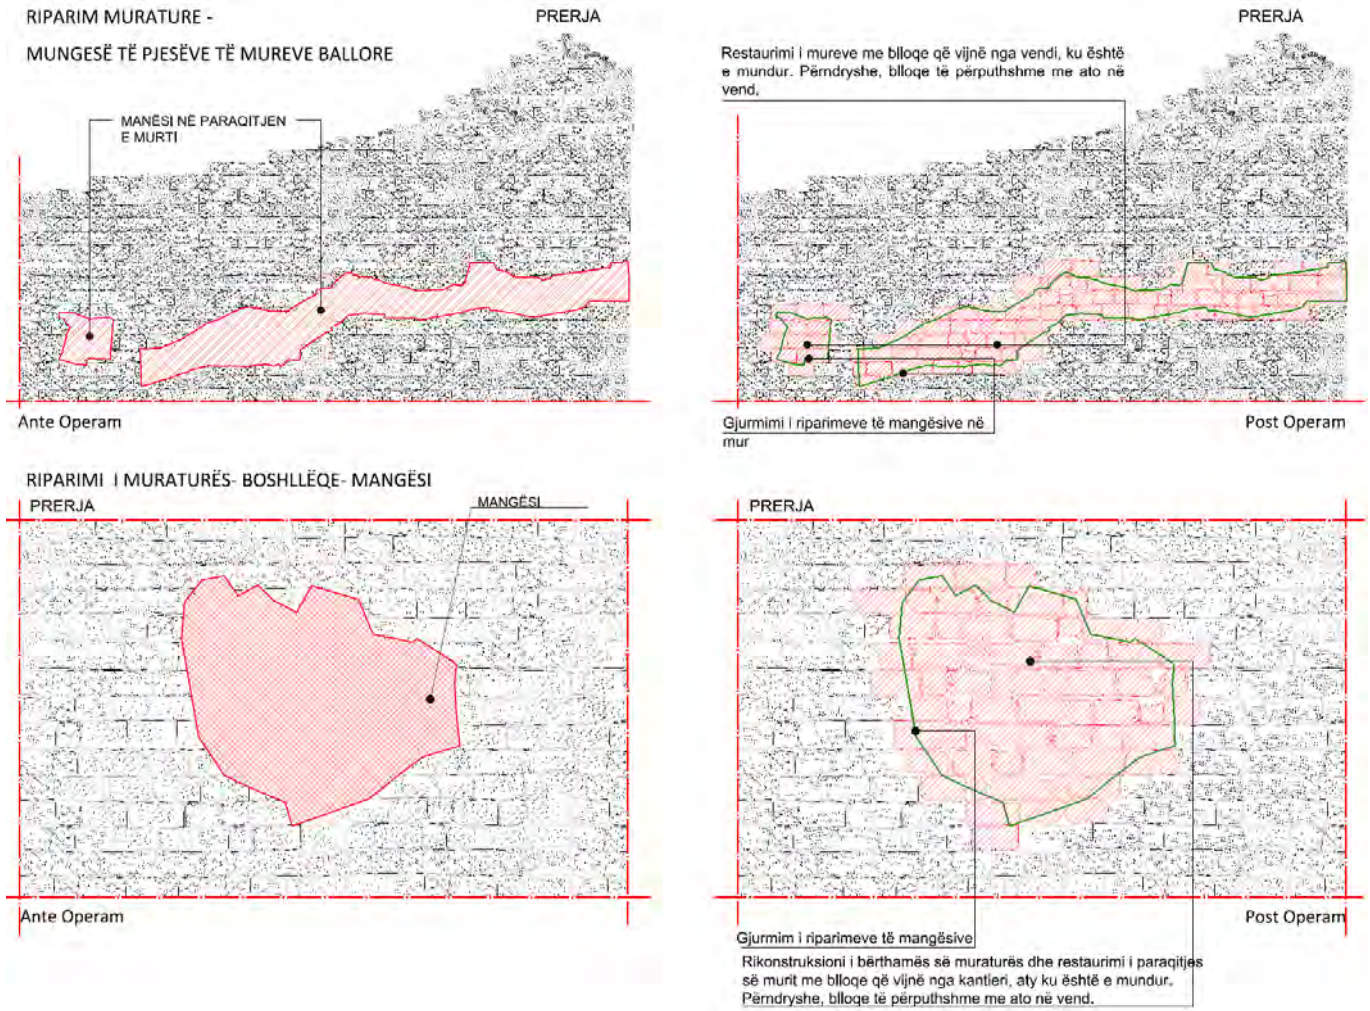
Detaje të restaurimit të muraturës që ka mungesa dhe boshllëqe
